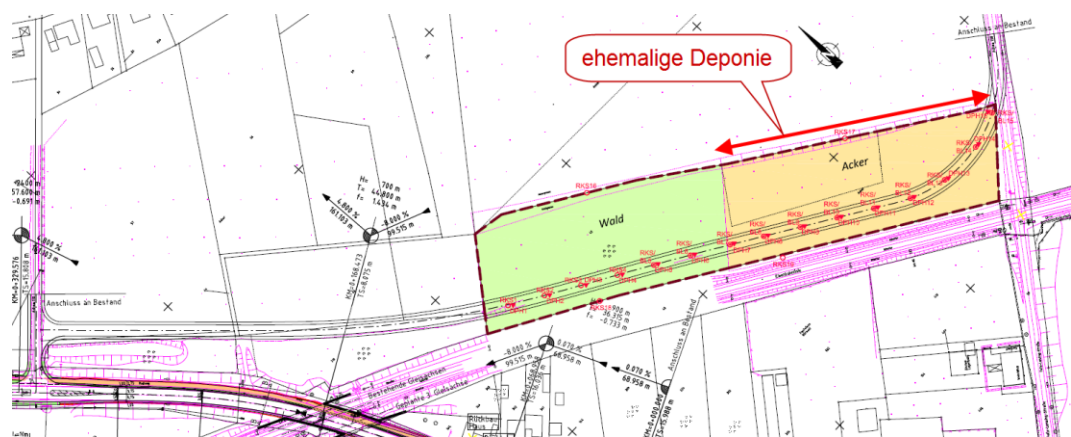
Lageplan der Bohrpunkte (Tauw, 2014)
